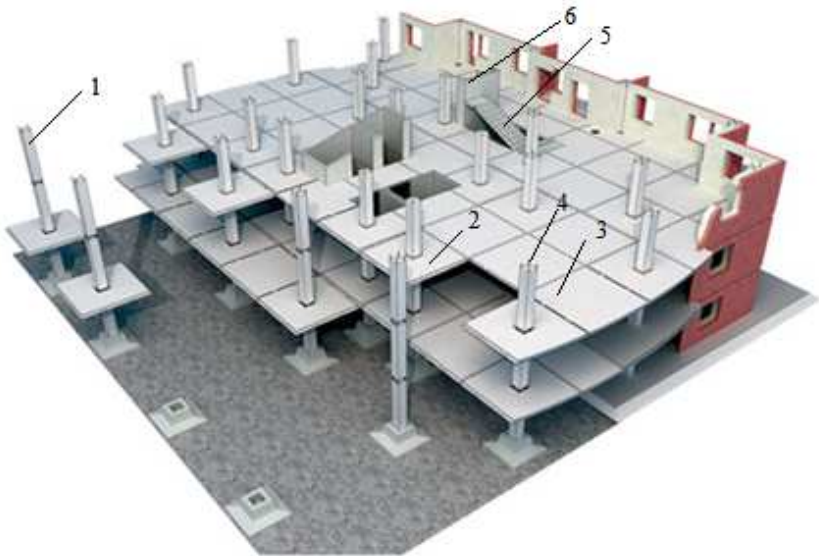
Схема безригельно-безкапітельної збірно-монолітної конструктивної системи житлової будівлі: 1 – колона; 2 – надколонна плита; 3 – міжколонна плита; 4 – середня плита; 5 – сходовая клітка; 6 – елементи жорсткості
